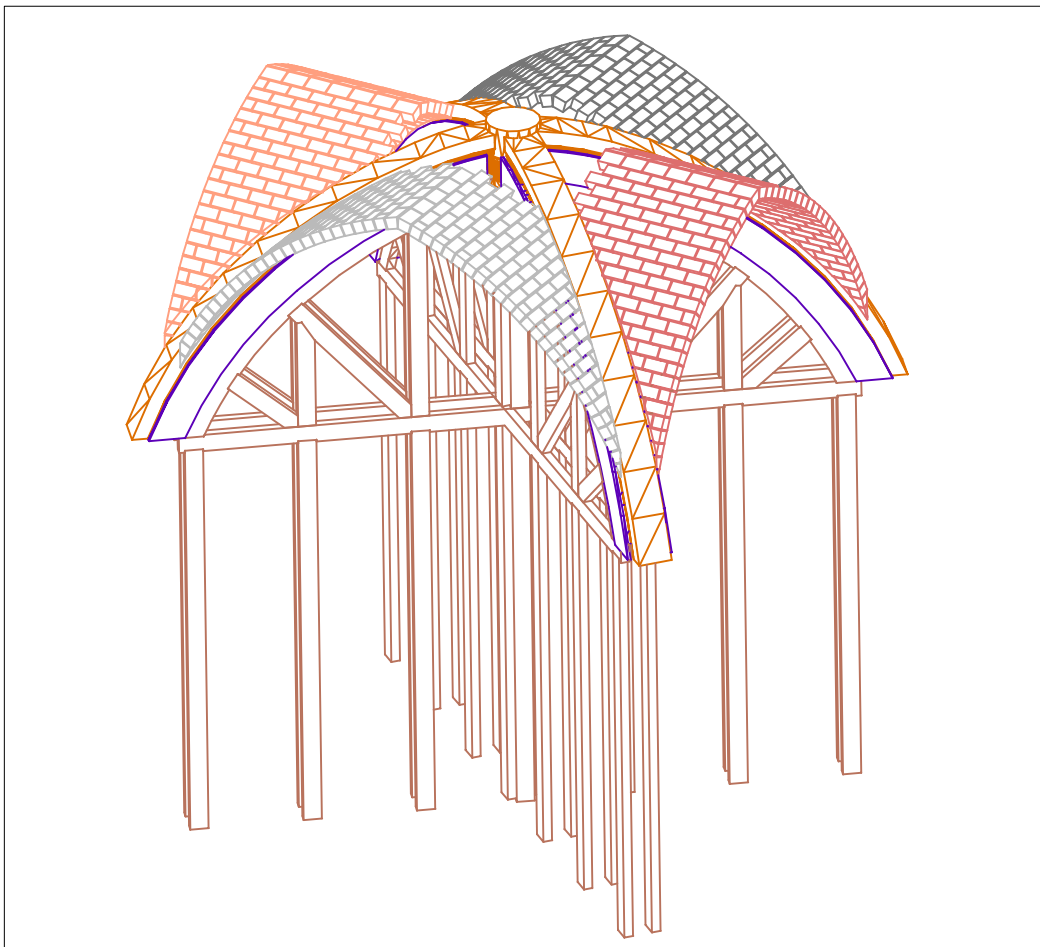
PRIMEIRA FASE DE DESCONSTRUÇÃO
